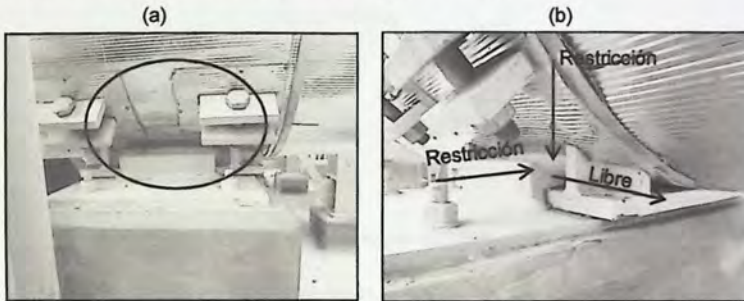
a) Cañería con sistema de apoyo tipo guía. b) Restricciones y desplazamientos permitidos del apoyo.
